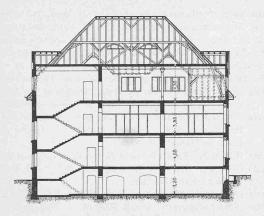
und 3. Schnitt und Grundrisse. - 1:400.
